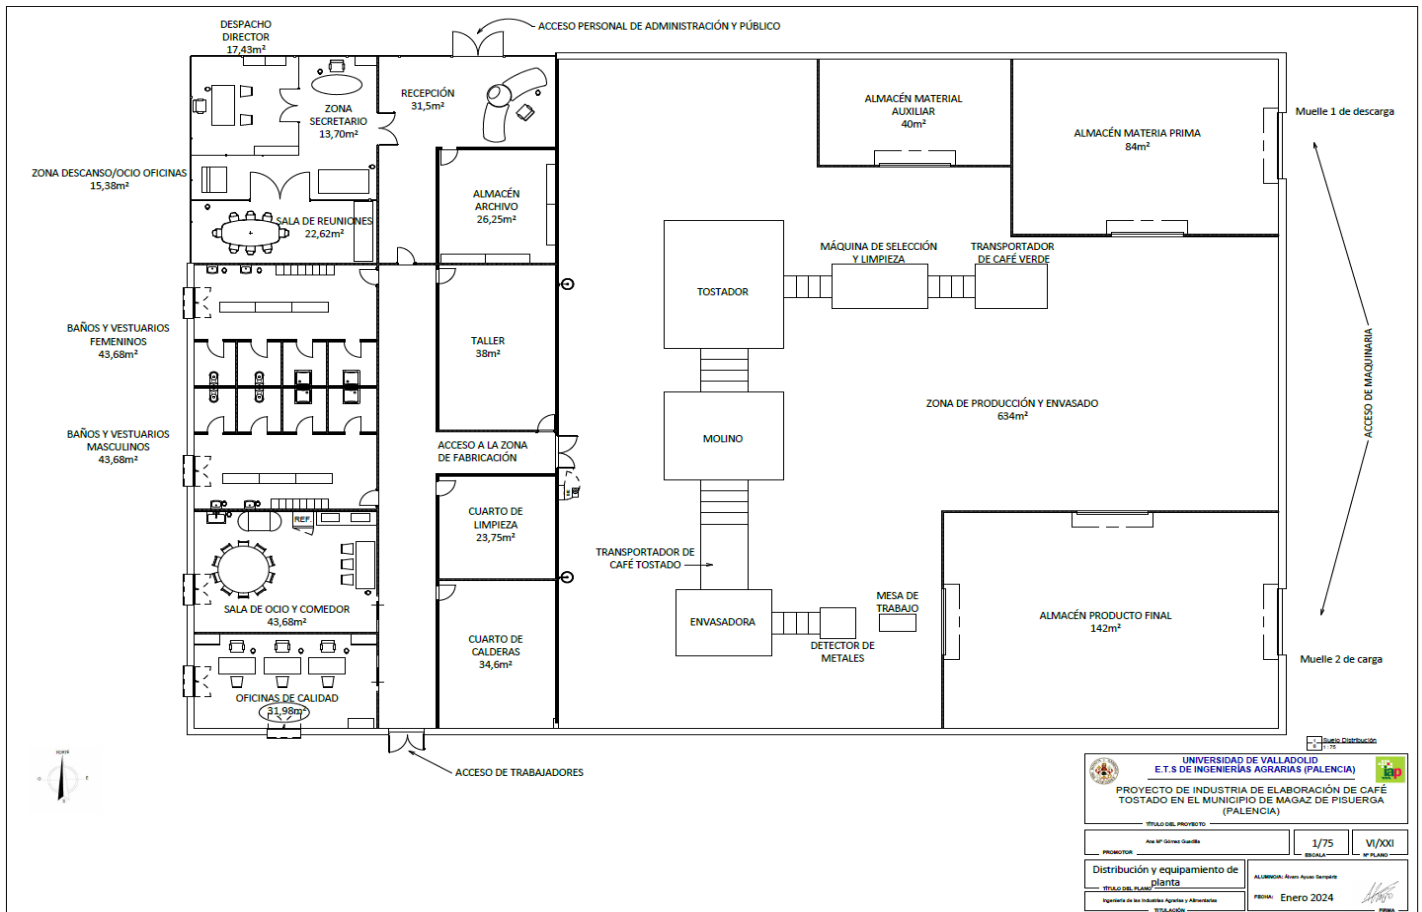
Plano de disposición en planta de la nave de producción de café tostado.
